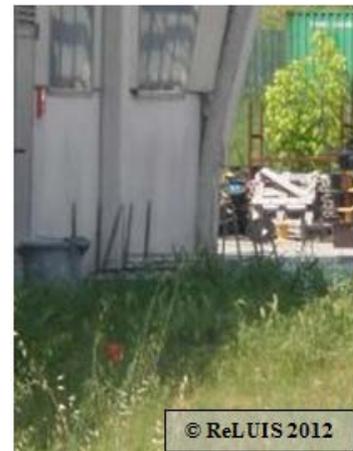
Perdita di verticalità del pilastro per rottura alla base per cause non accertabili
